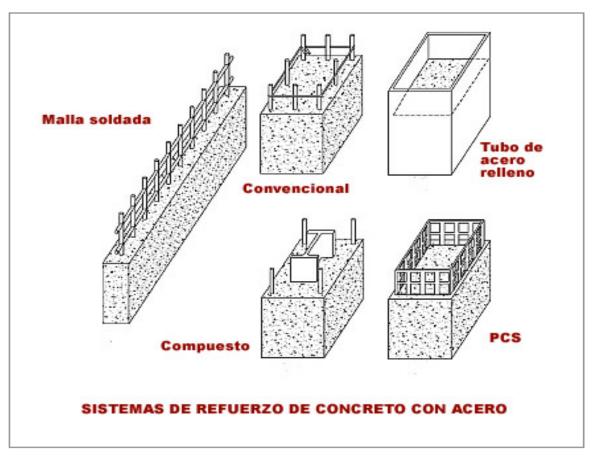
Sistemas de refuerzo de concreto con acero. (Fuente: http://www.ingenieria.peru-v.com)
